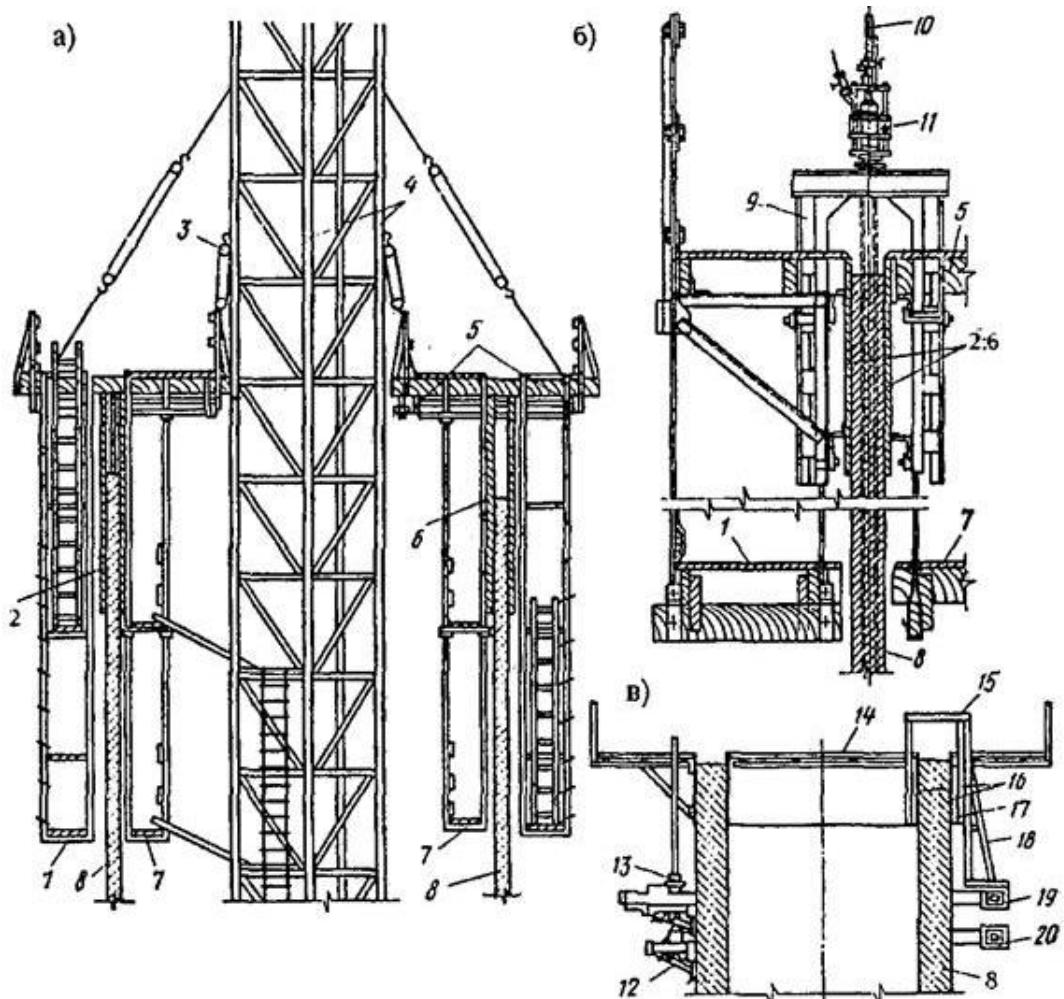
Бетонирование стен ствола водонапорной башни:
